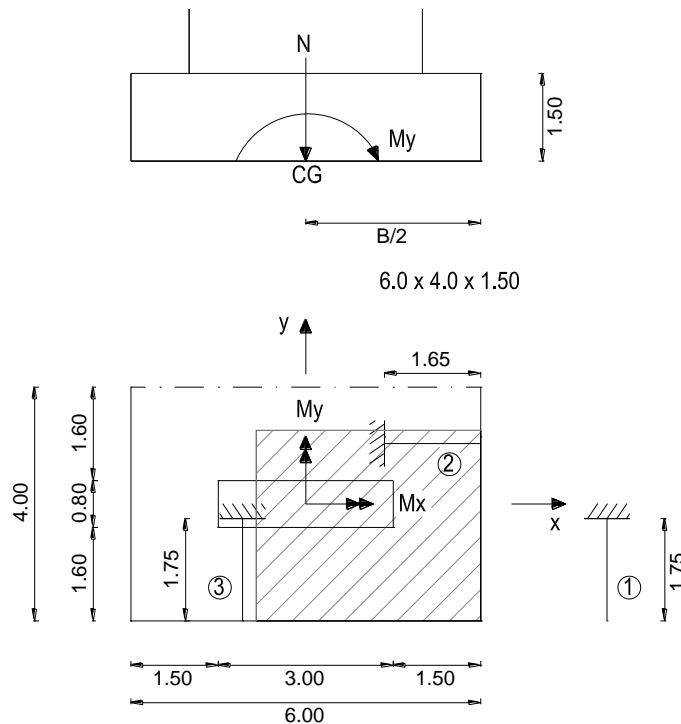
GEOMETRIA E MODELO DE CÁLCULO DAS SAPATAS DE FUNDAÇÃO DOS ENCONTROS
